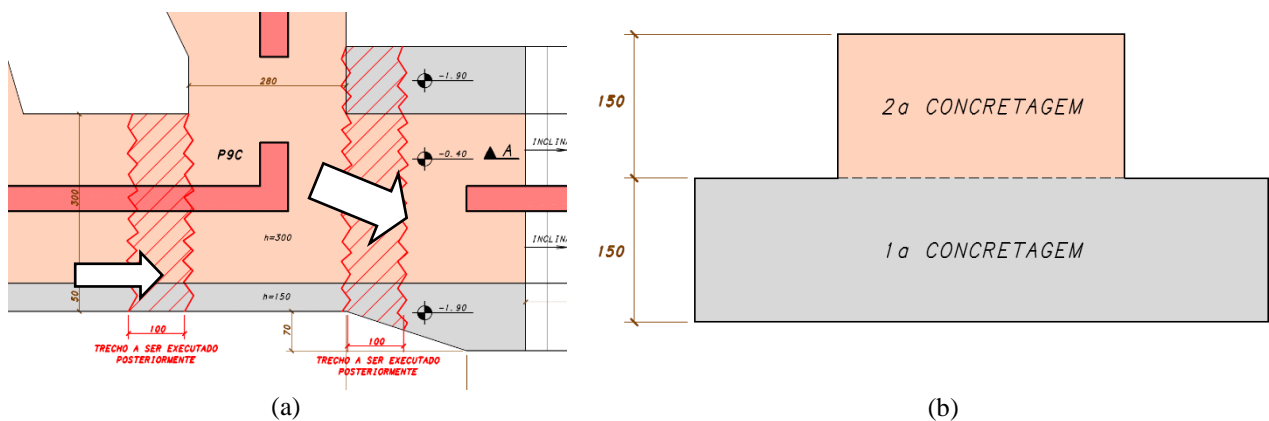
(a) Detalhe do trecho a ser executado posteriormente com largura igual a 1 m (b) Corte esquemático para concretagem dos segmentos da sapata da obra Faria Lima Plaza
